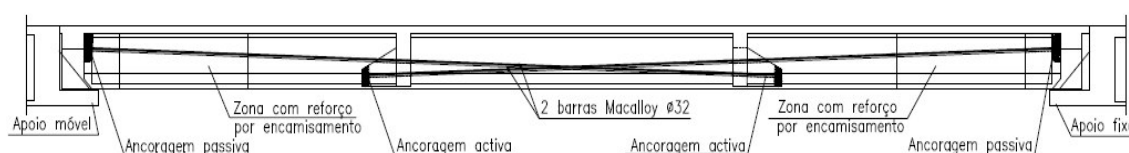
Alçado longitudinal tipo de uma viga interior (Válter J. G. e Ramos, Lúcio e António M., 2000)
